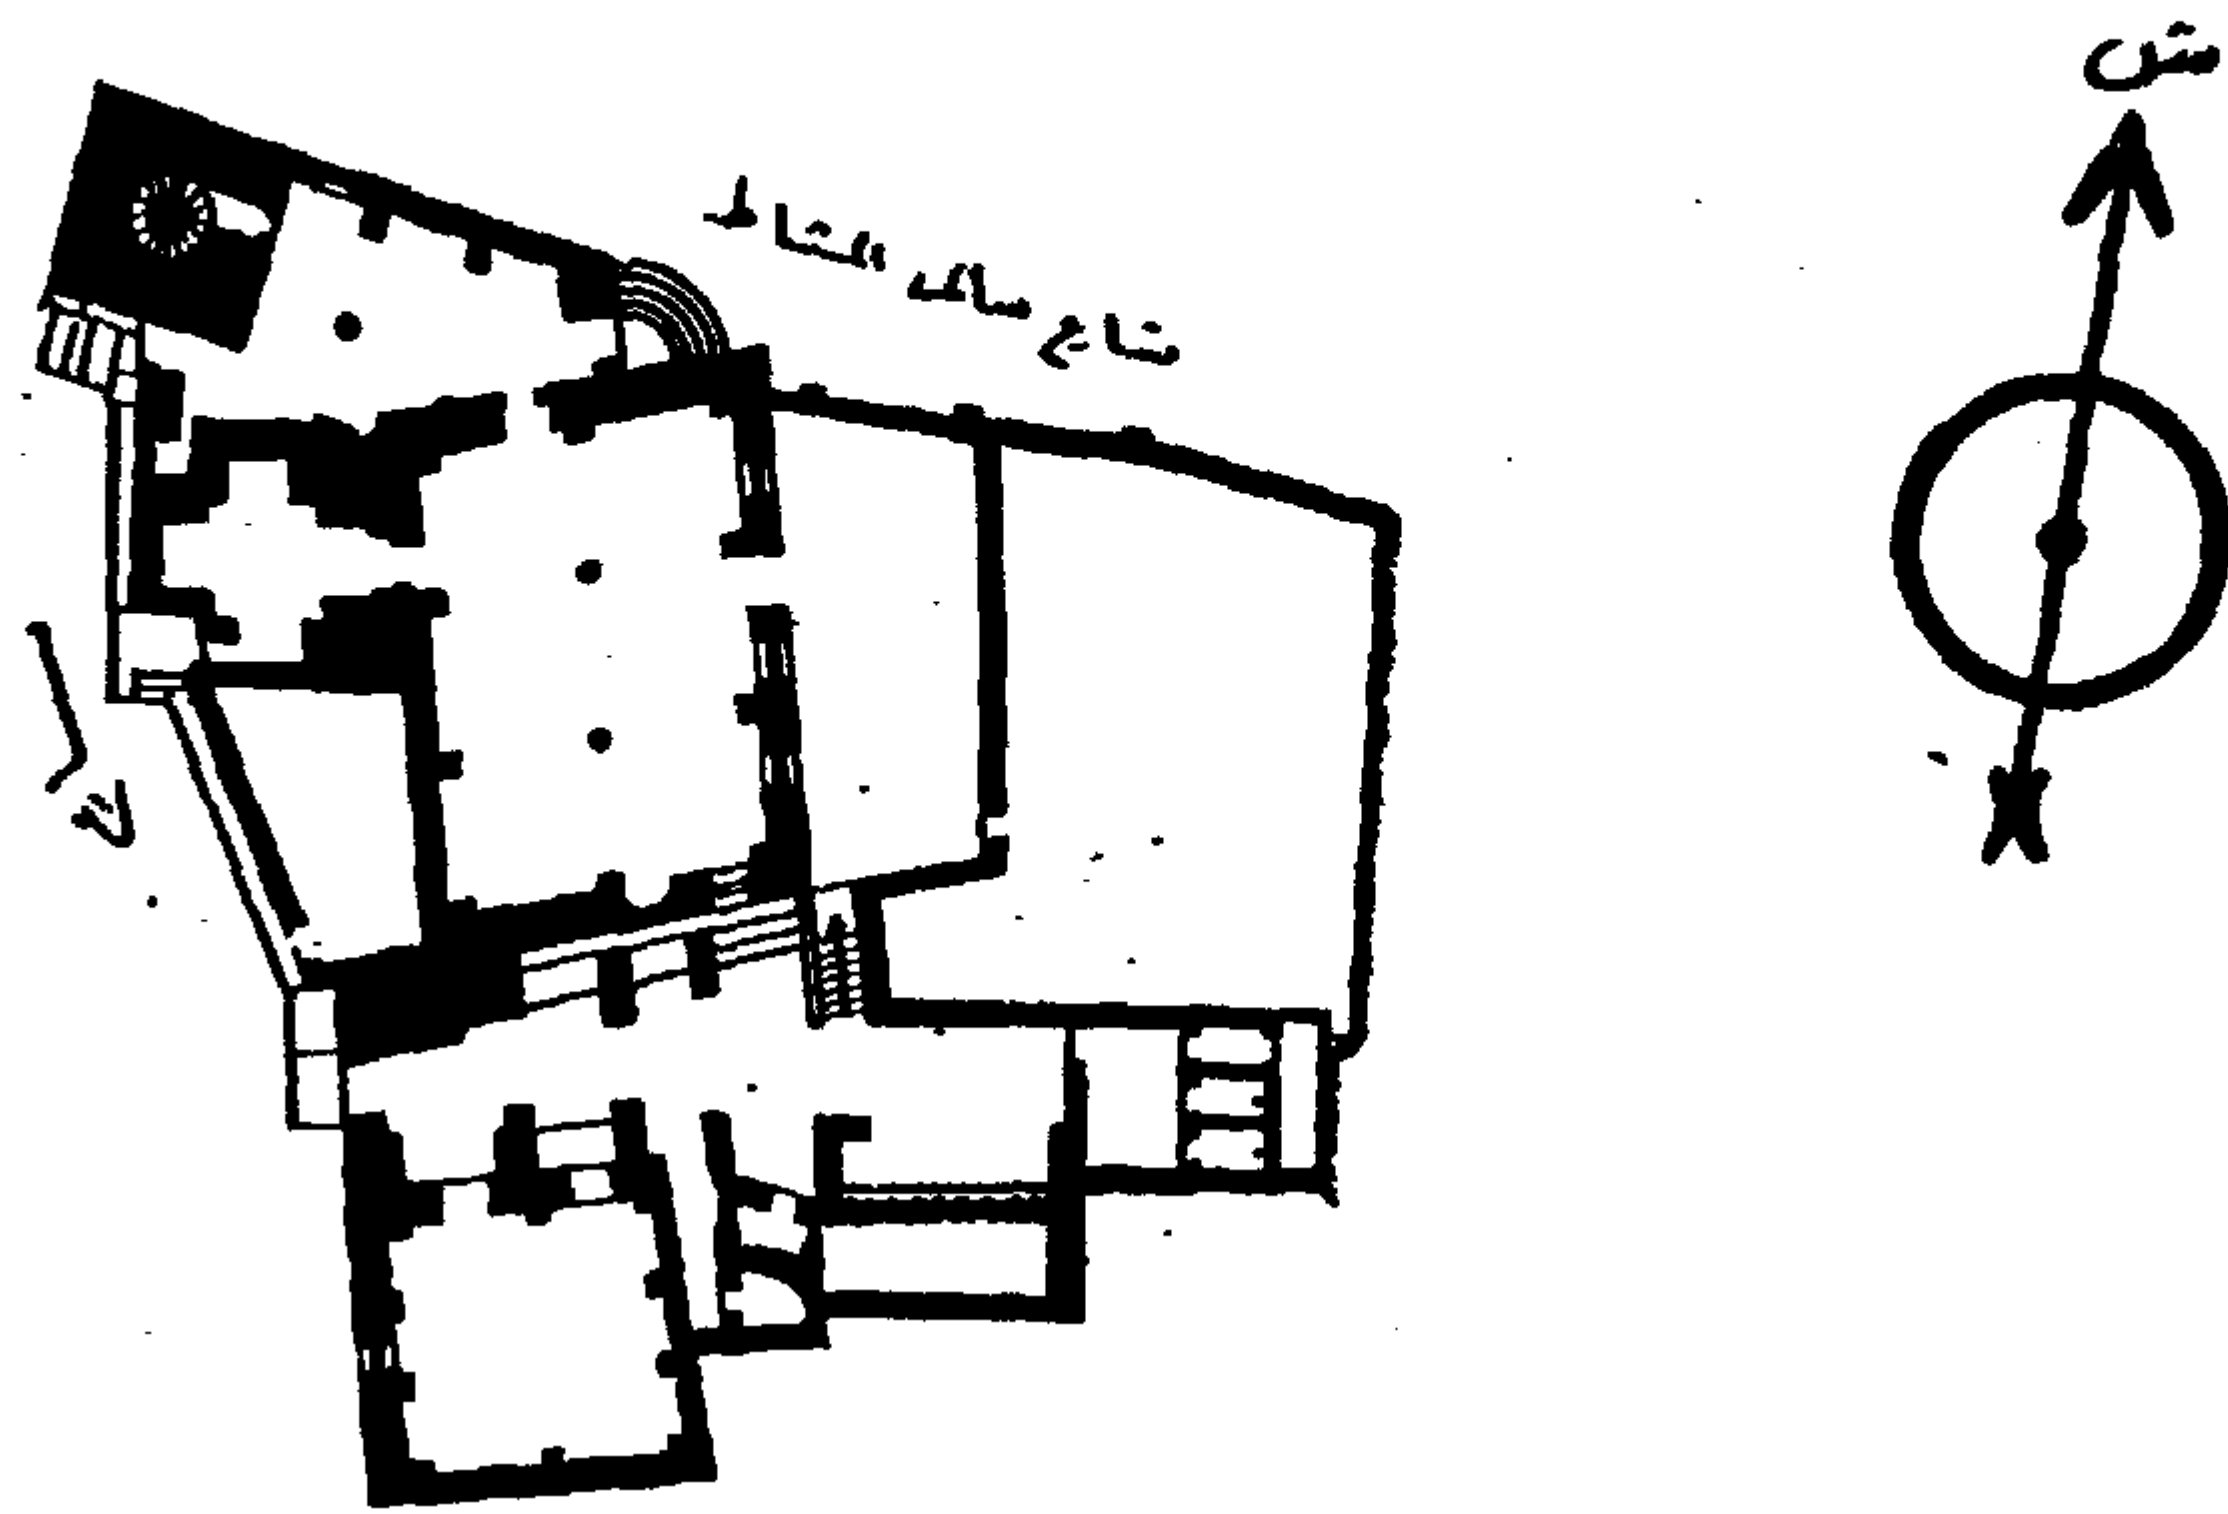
مسقط أفقي لمسجد محمود عن موسوعة الآثار الإسلامية.
